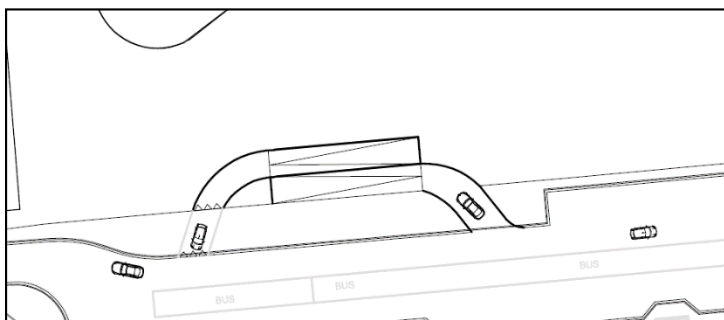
Accès au parking souterrain depuis la rue de la Citadelle (source : BAEV)
